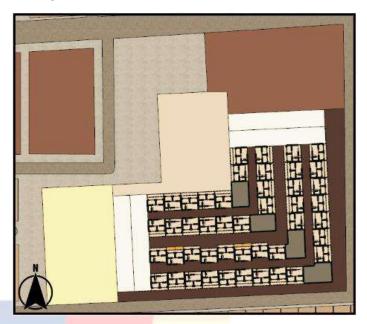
Denah Lantai 1 Gubahan Massa 2
